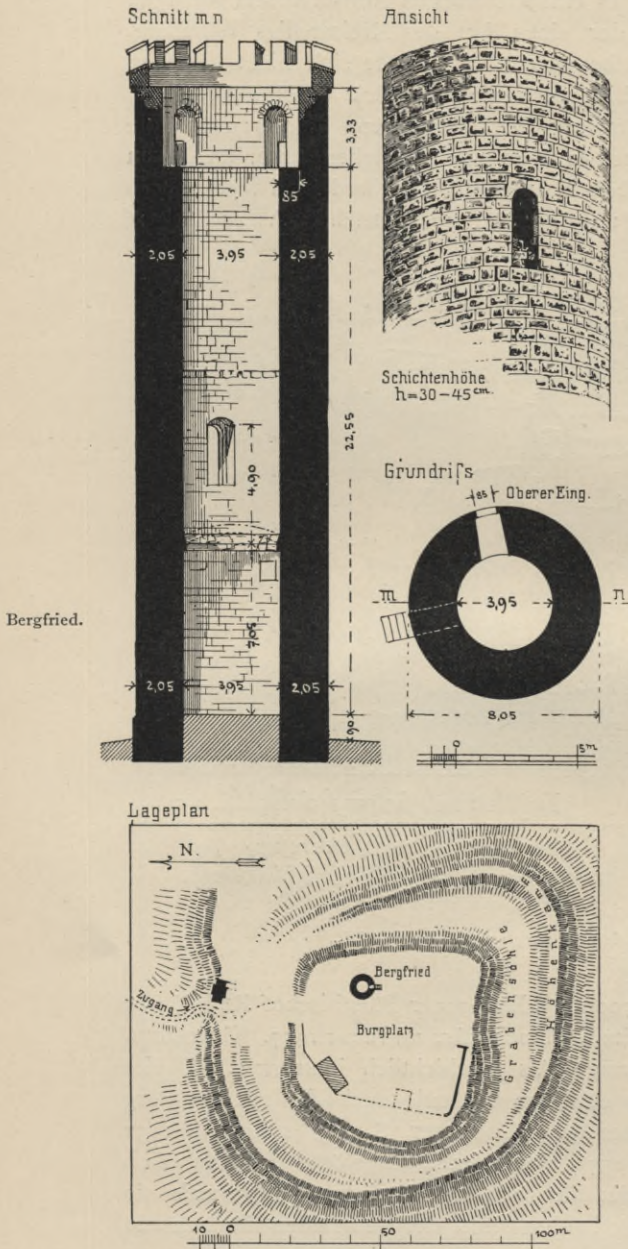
Eltmann. Wallburg. Lageplan und Bergfried.
